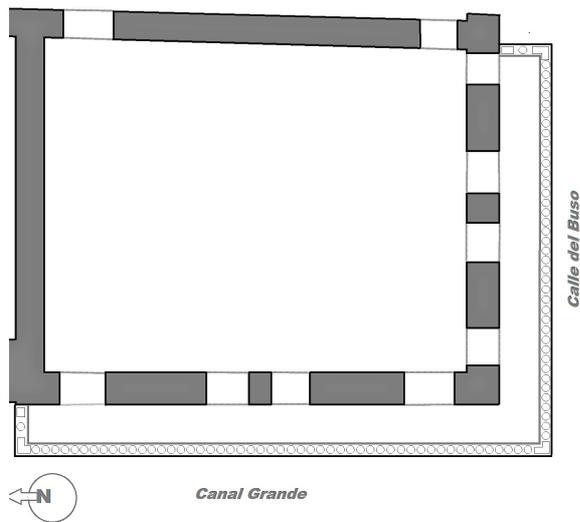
Grundriss der Sala d'estate im Fondaco dei Tedeschi in Venedig, um 1580.
